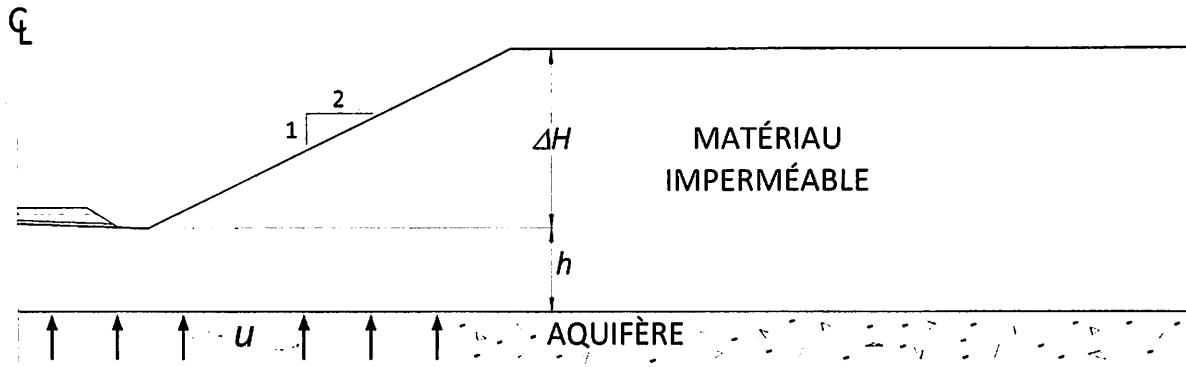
Aquifère artésien sous la chaussée en coupe.
